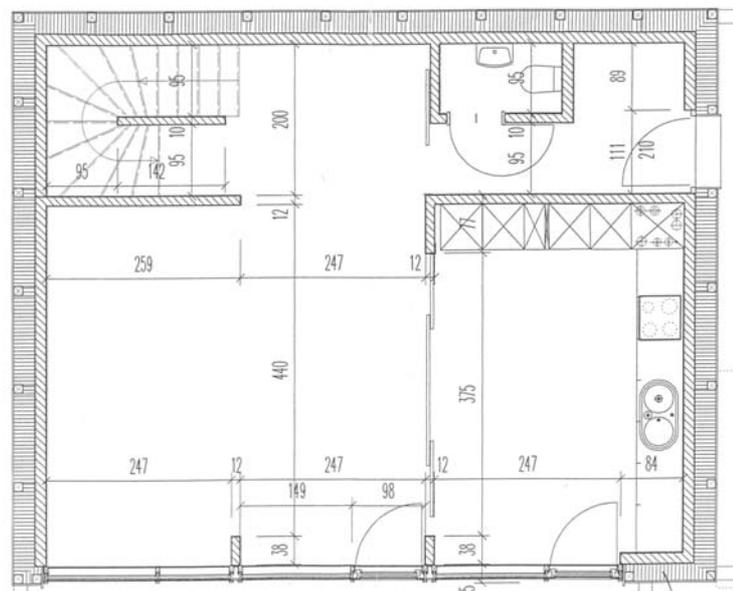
Grundriss Erdgeschoss Haus „Chräbsbach“
